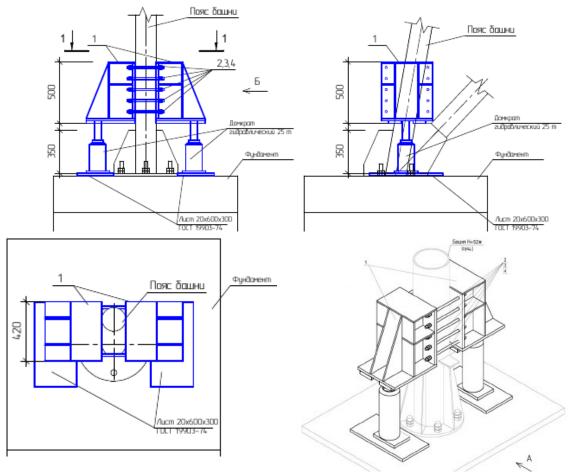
Схема установка домкратов на опорную конструкцию в местах опирания пояса башни
